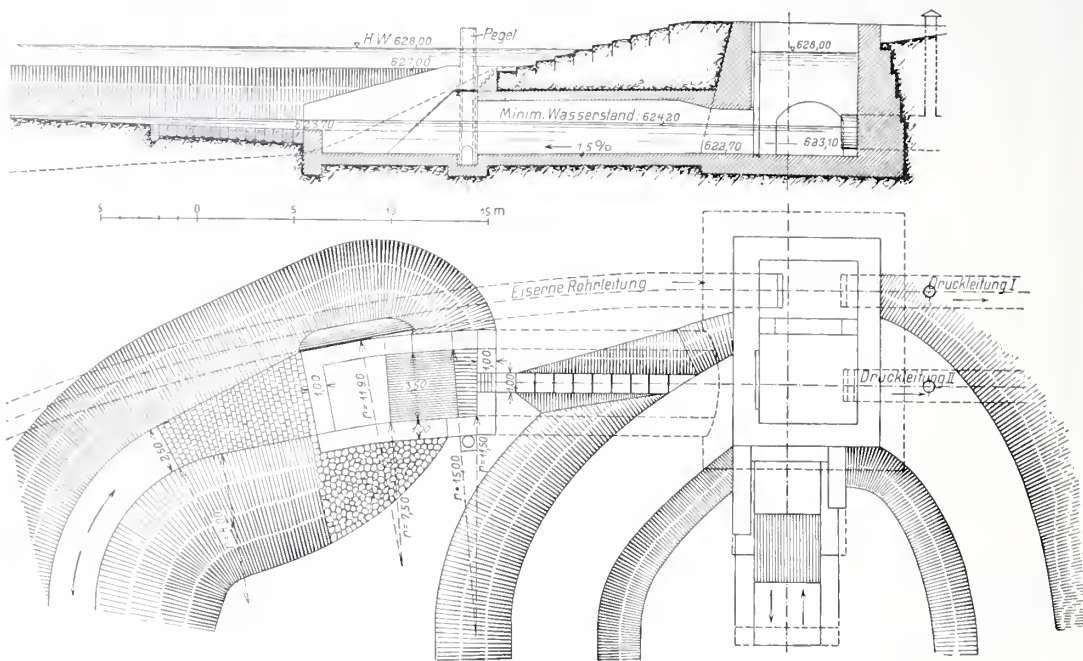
Längsschnitt und Grundriss durch das Wasserschloss der Kanderleitung. — Masstab 1 : 400.
